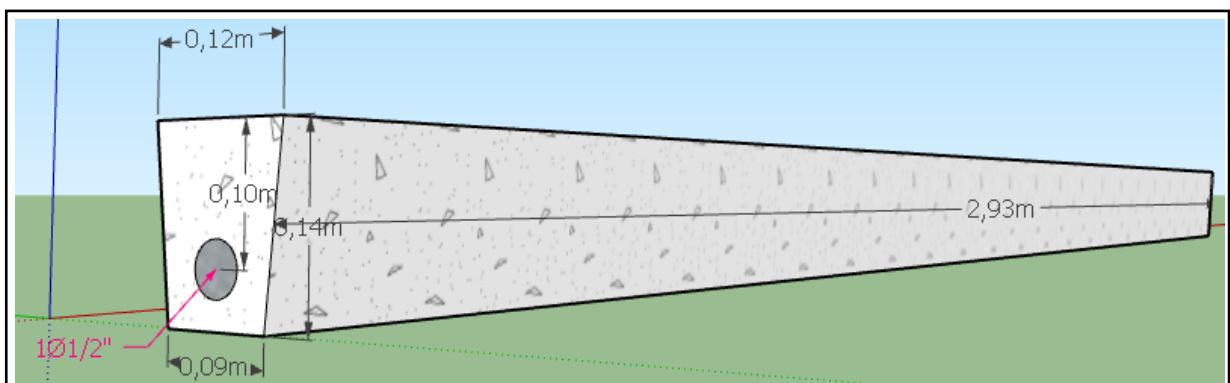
Vista en 3D de la vigueta pretensada V2.
